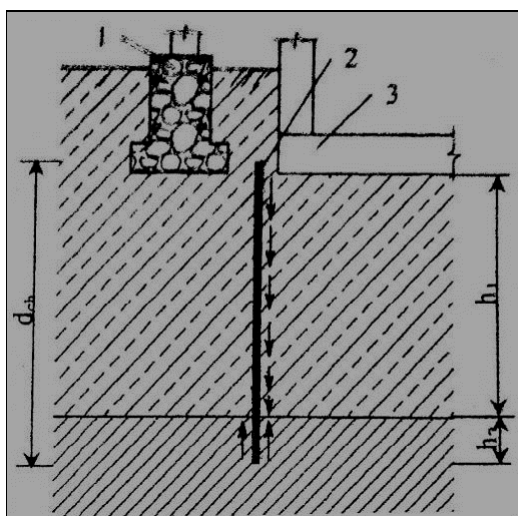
Разделительная стена: 1 – фундамент существующего здания; 2 – разделительная стена; 3 – фундамент нового здания
